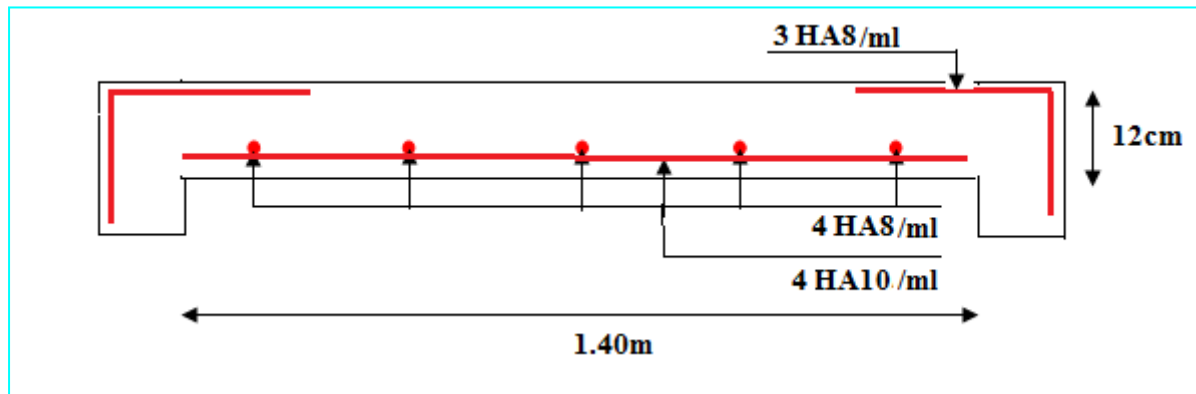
Schéma de ferraillage de la dalle sur trois appuis.
